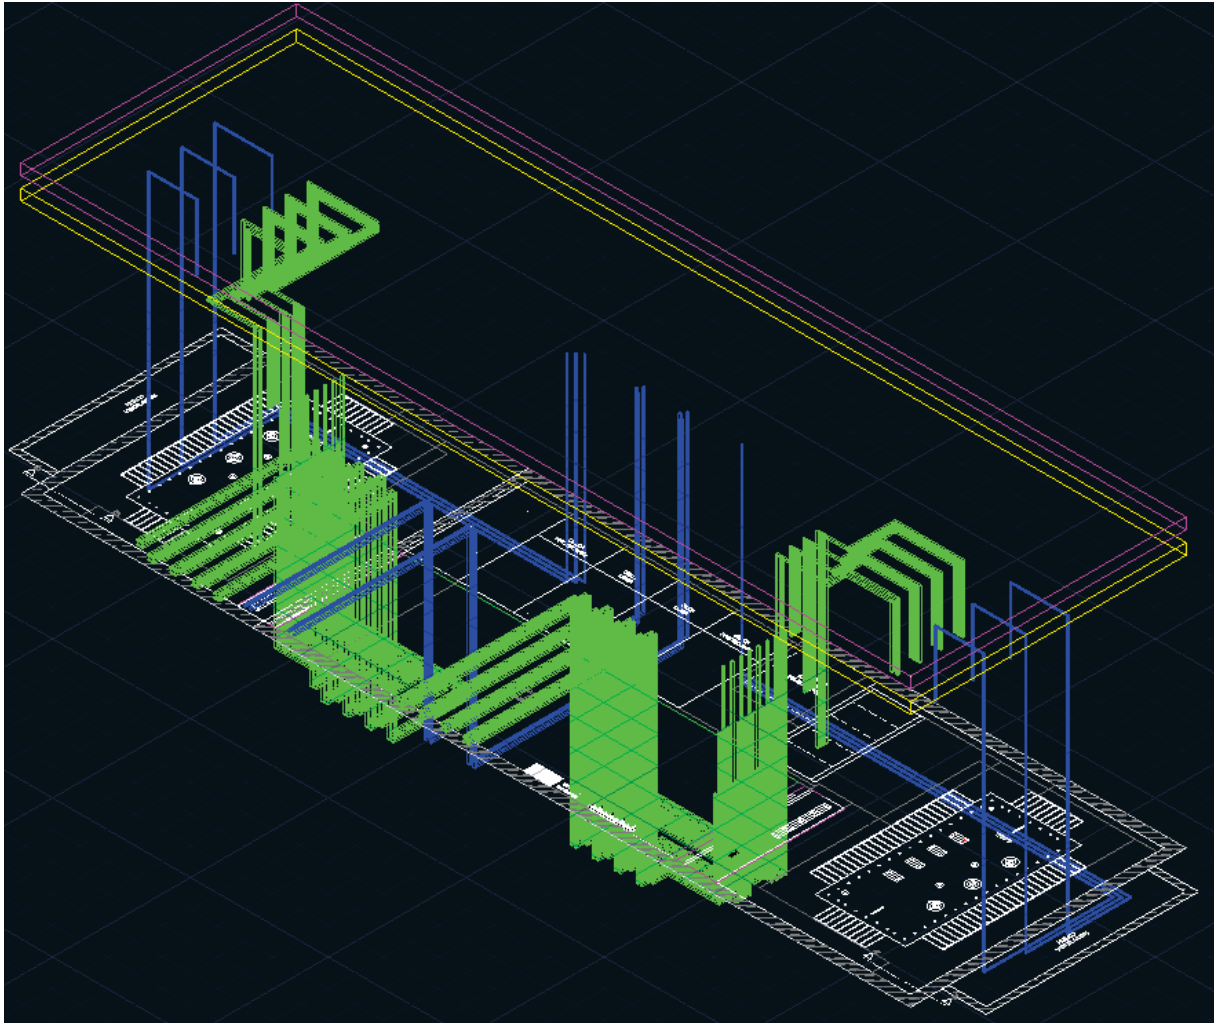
Vista isométrica de la instalación (2L+2T [Sub]) (cotas en mm).
